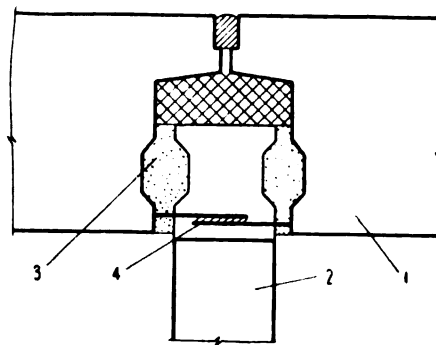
Связи самонесущих наружных стен между собой и с внутренними стенами
